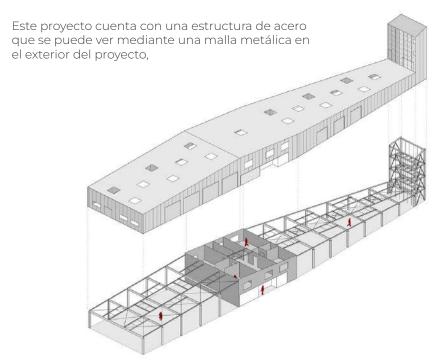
Sistema Constructivo Fuente: Adaptado por el Autor, 2024
